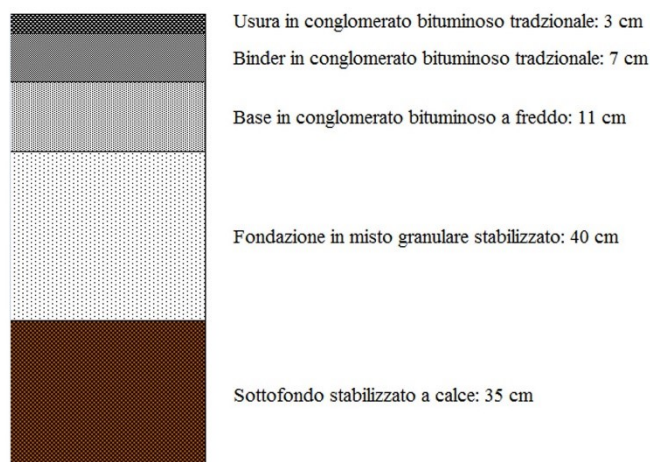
Stratigrafia di un pacchetto strutturale di una pavimentazione stradale flessibile
